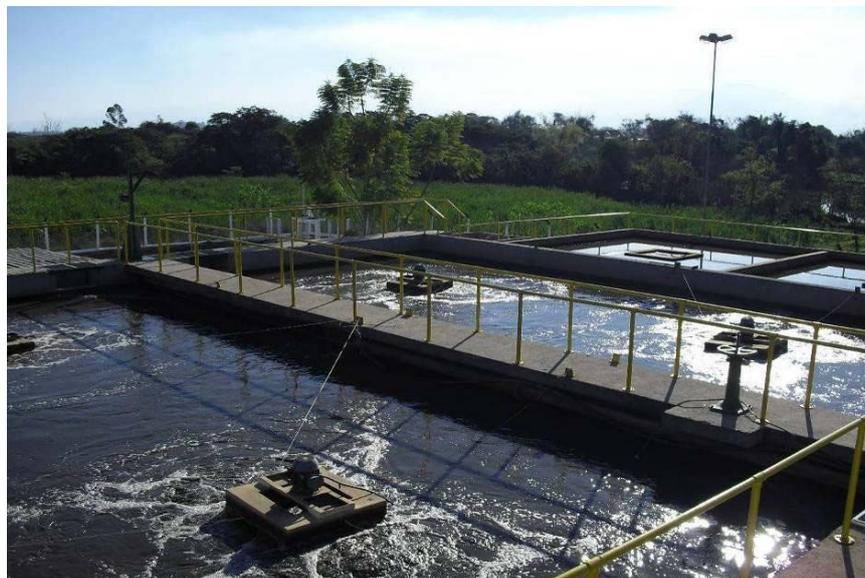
ETE Campo do Galvão – Tanques de Aeração.
